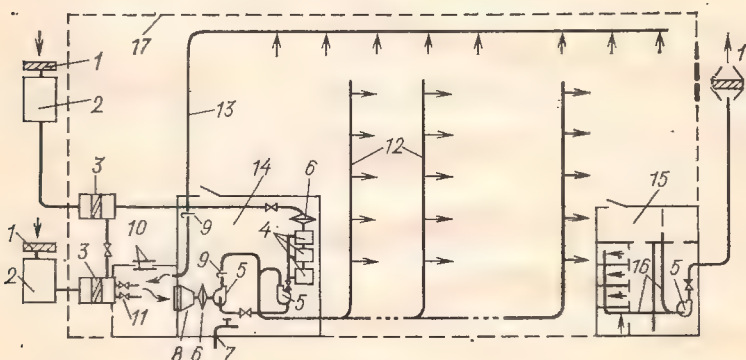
Принципиальная схема вентиляции убежища с фильтровентиляционным комплектом ФВК-1:
